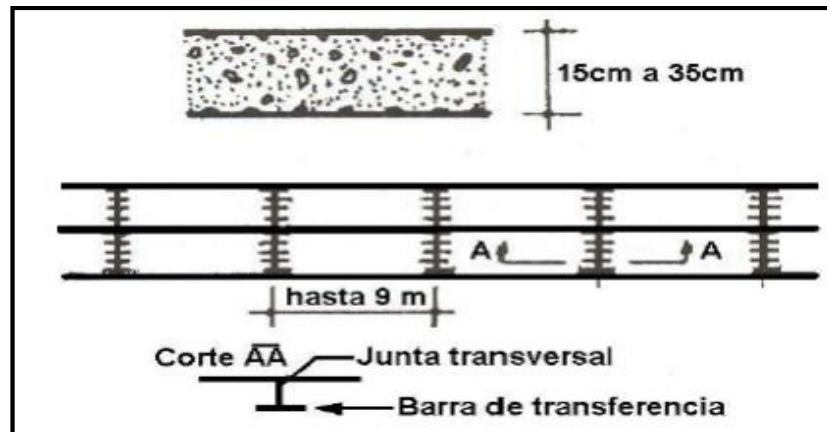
Pavimento de concreto simple con elementos de transferencia de carga.
